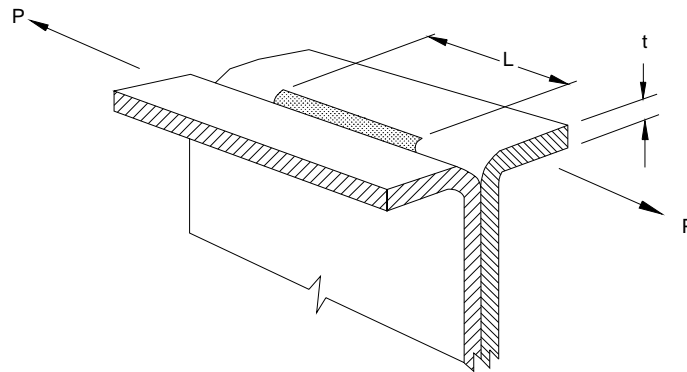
C Corte en una soldadura de ranura biselada en V
